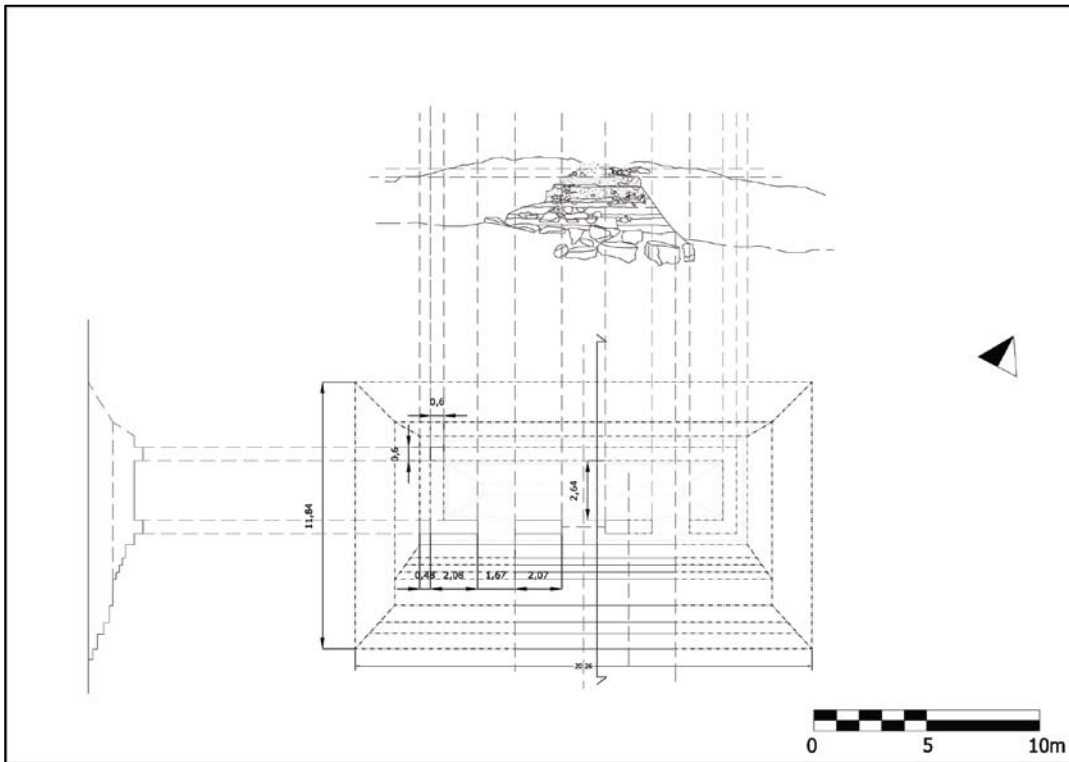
Levantamiento con propuesta reconstructiva de tres accesos. (Elaboración A. Campiani)
